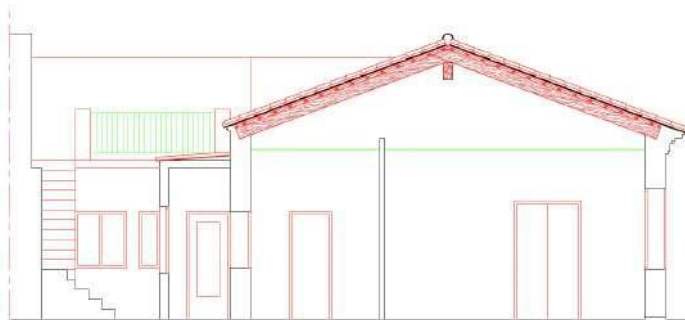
Sección A de la planta distribución carpinterías de vivienda existente. Fuente propia
